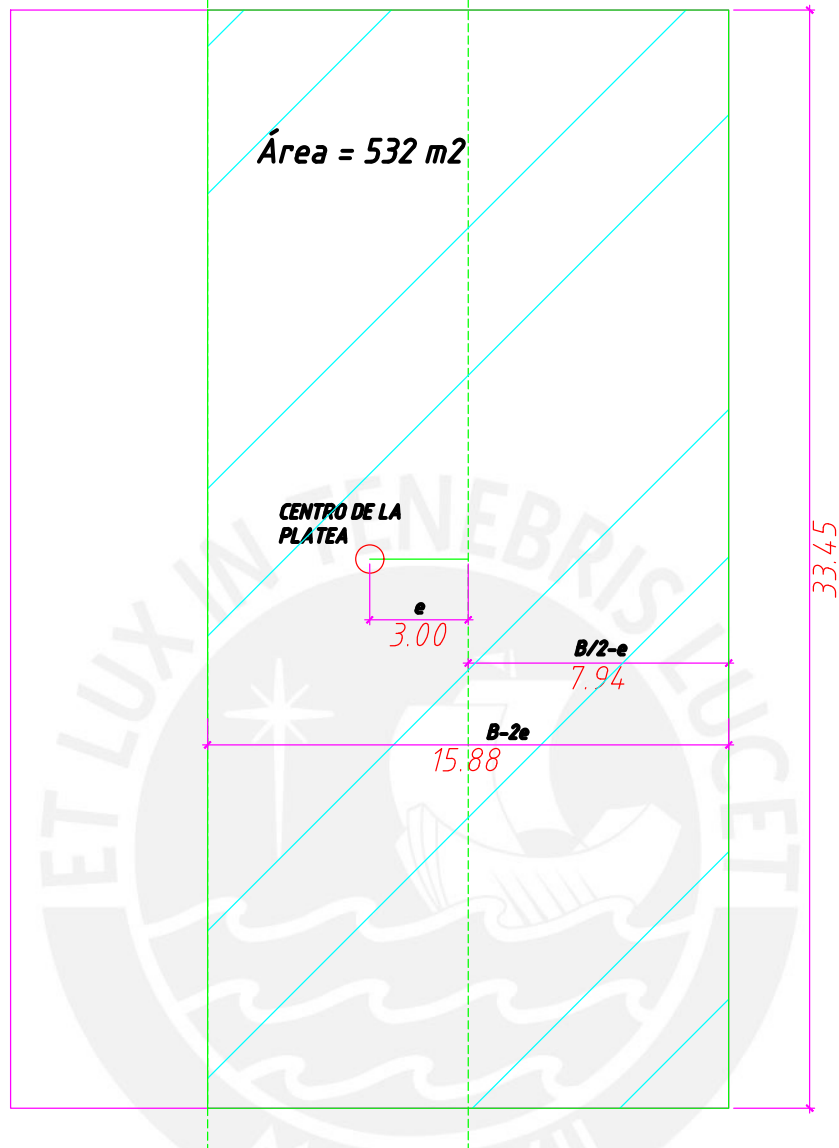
Cálculo del ancho efectivo para la dirección XX según Meyerhof
